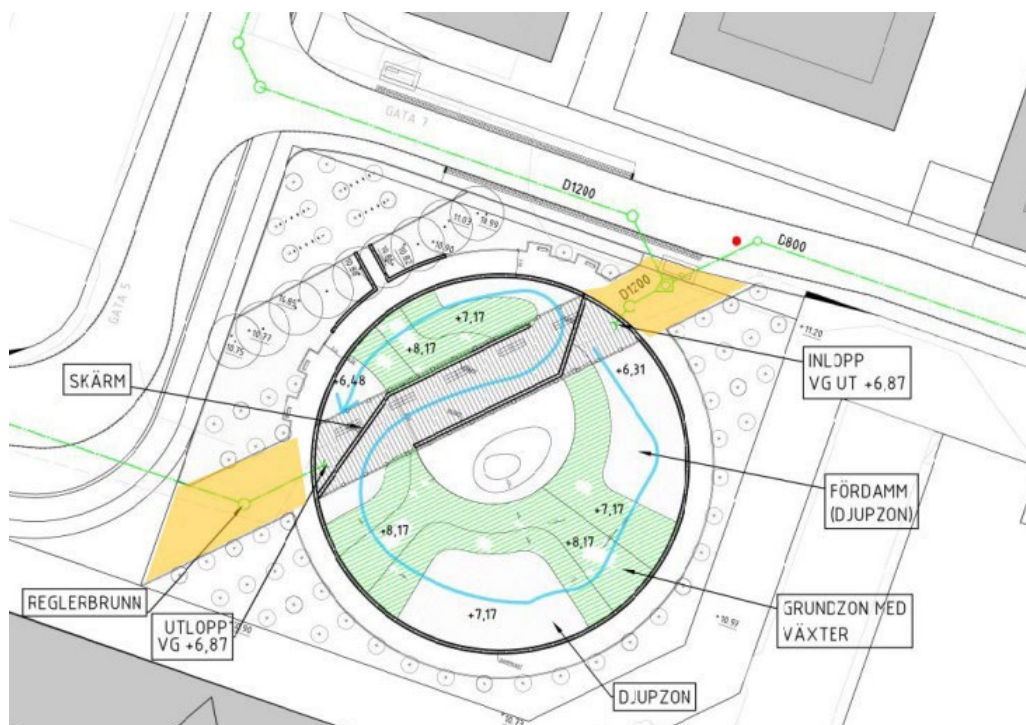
Illustration av dammens utformning i plan. Dammen är en del av parken vid Virdings plats där en bryggkonstruktion möjliggör passage över dammen. Vattnets flödesväg illustreras med blå linje. Yta som kan användas för avvattning av sediment är illustrerat med gult.
